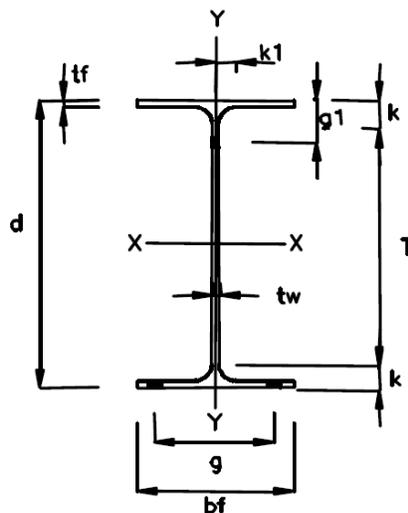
Perfil I rectangular proporcional a las traveses metálicas (IMCA, 2002)
